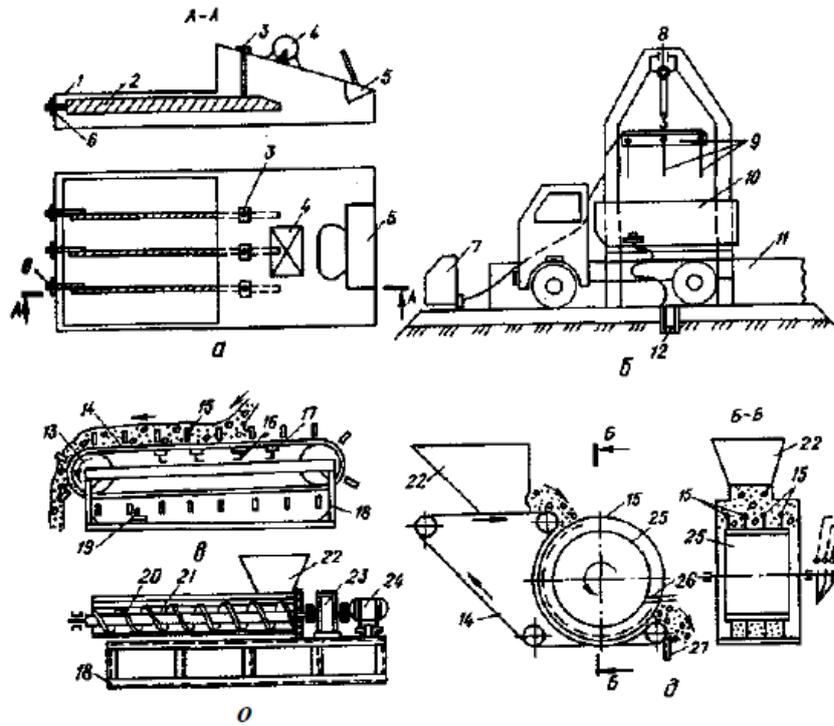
Схеми устаткування для попереднього електророзігрівання бетонної суміші: а – баддя; б – пост електророзігрівання бетонної суміші у кузовах автосамоскидів; в – установка безперервної дії конвеєрно-стрічкового типу; г – те саме, шнекового типу; д – те саме, барабанно-стрічкового типу; 1 – корпус бадді; 2 – пластинчасті електроди; 3,6 – елементи кріплення електрода; 4 – зовнішній вібратор; 5 – заслінка; 7 – щит керування; 8 – тельфер на порталі; 9 – рама з опускними електродами; 10 – кузов автосамоскида; 11 – огорожа; 12 – заземлення; 13 – барабан; 14 – конвеєрна стрічка; 15 – електроди; 16 – пристрій контактного підключення до електромережі; 17 – ізолятор; 18 – рама; 19 – вібромолоток для очищення електродів; 20 – шнек; 21 – труба-жолоб; 22 – приймальний бункер; 23 – редуктор; 24 – електродвигун; 25 – барабан; 26 – відсікач; 27 – пристрій для очищення стрічки
